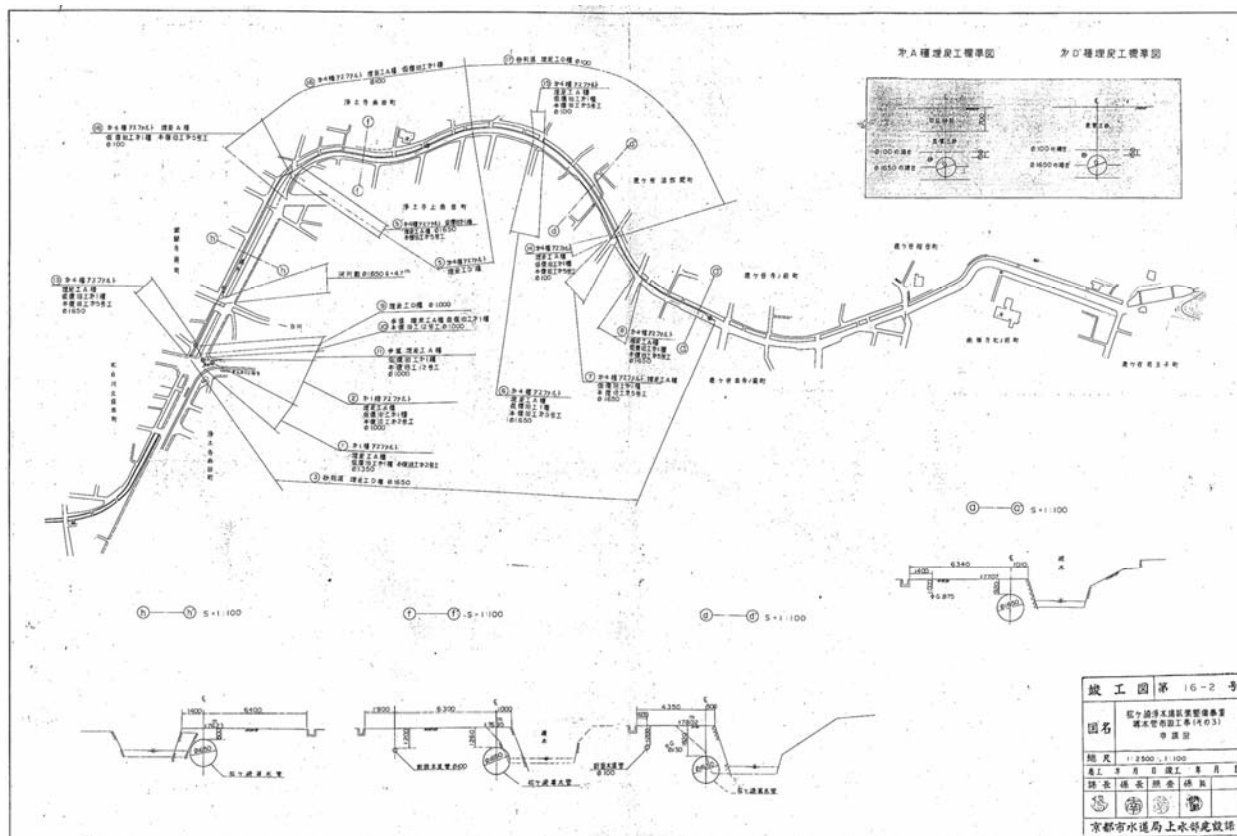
松ヶ崎浄水場導水管布設工事の平面・断面図
